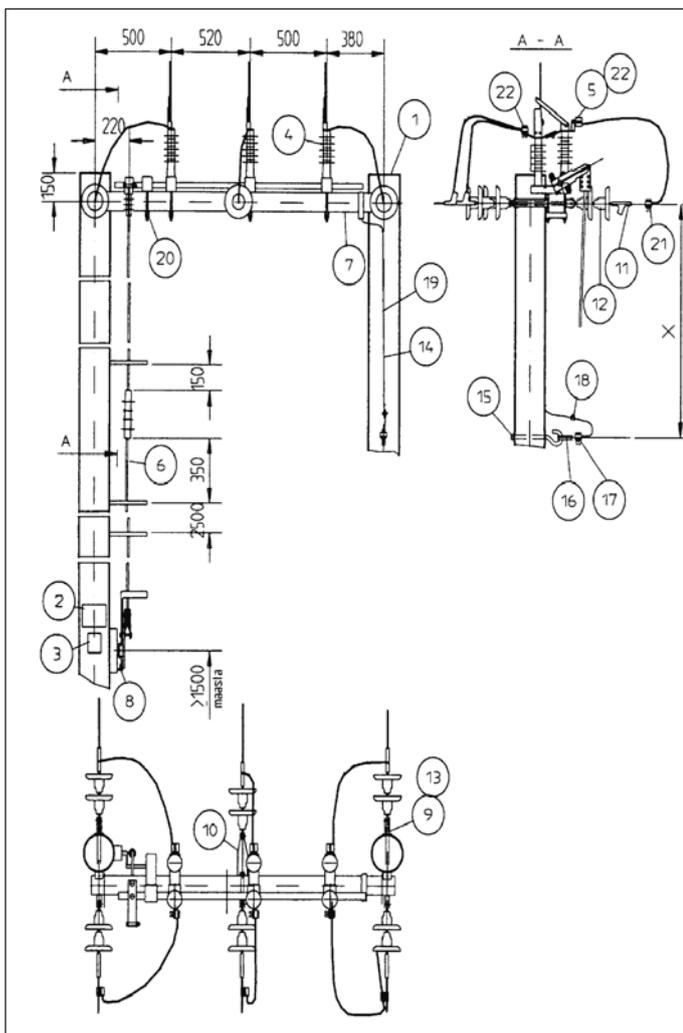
Конструкция верхней части разъединителя с центральным размыканием и проходящим проводом
